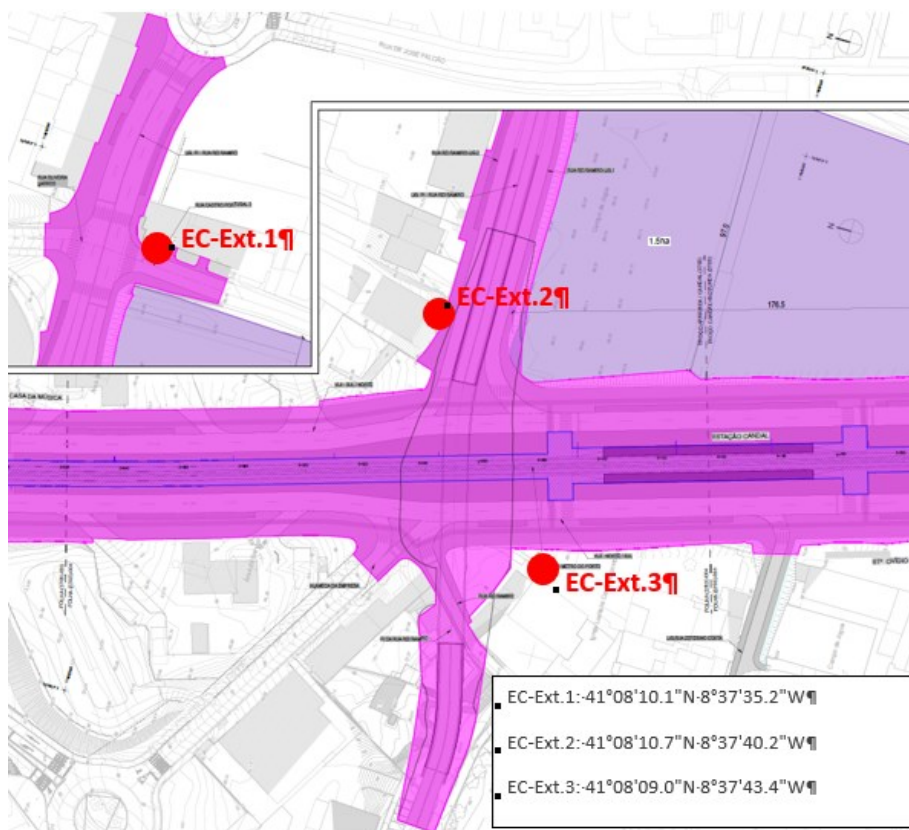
Pontos de monitorização junto Estação Candal (ruído – construção)
